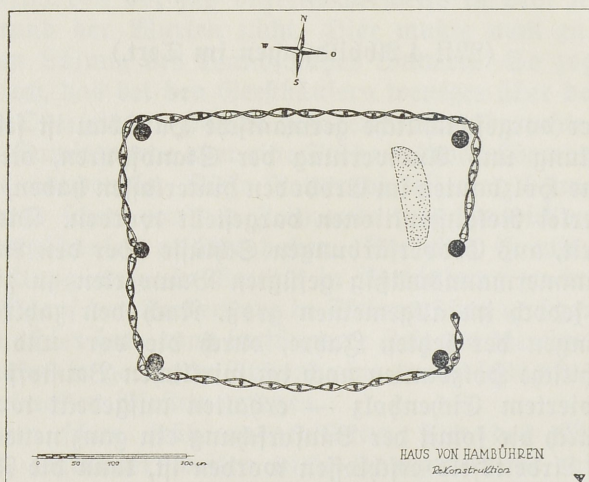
Haus von Hambühren. Rekonstruierter Grundriß.
